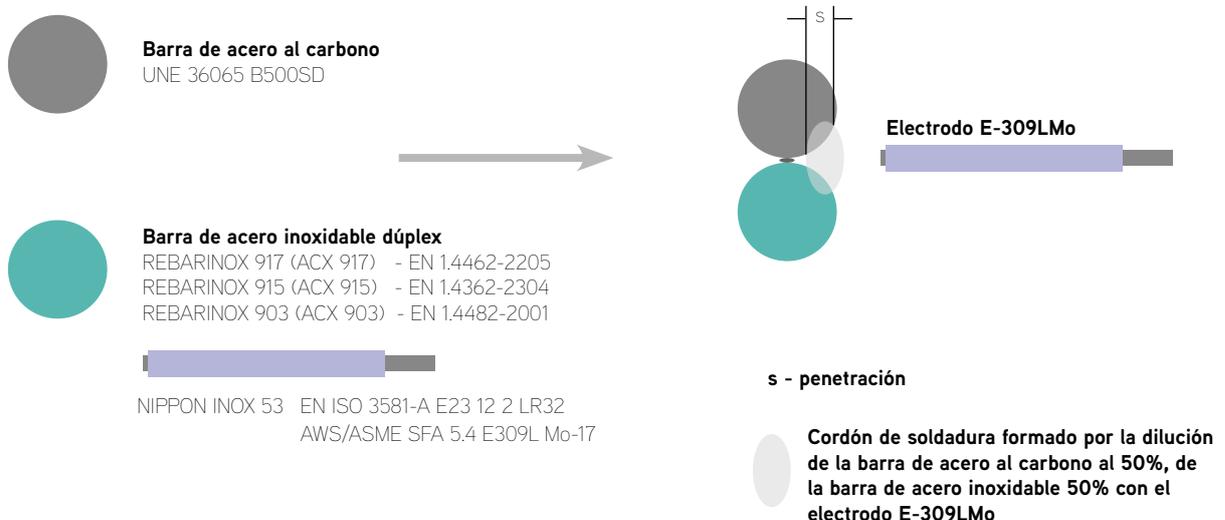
Esquema de la soldadura desde un solo lado, de la barra de acero al carbono corrugado a la barra de acero inoxidable dúplex
